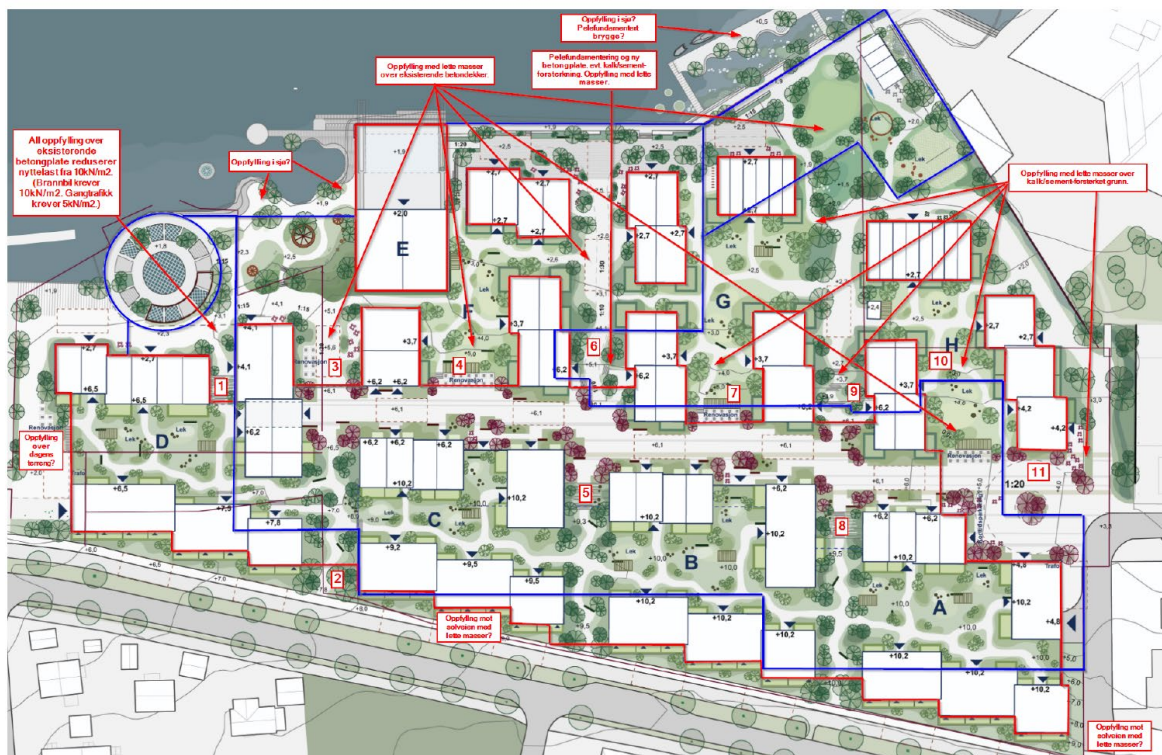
pelede betongdekker med angitt lastkapasitet (fra ref.[5])
